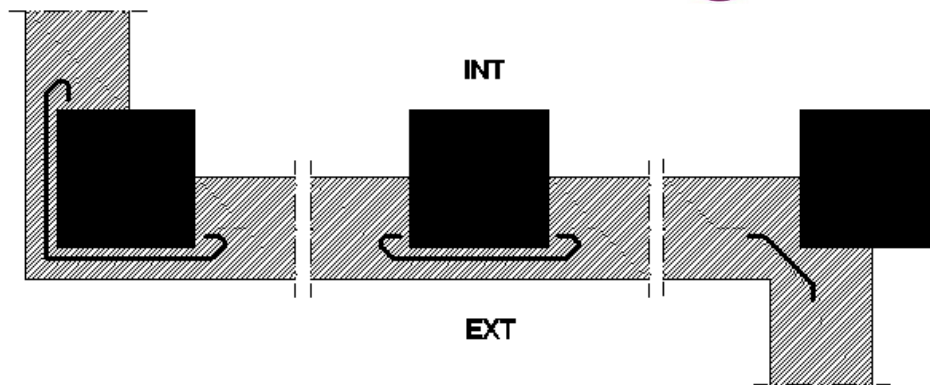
Ejemplo de encuentro de la fachada con los pilares
